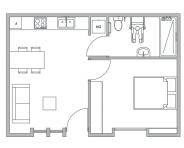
Planta Departamento Tipo E, Anteproyecto Fuente: Autores, 2022
